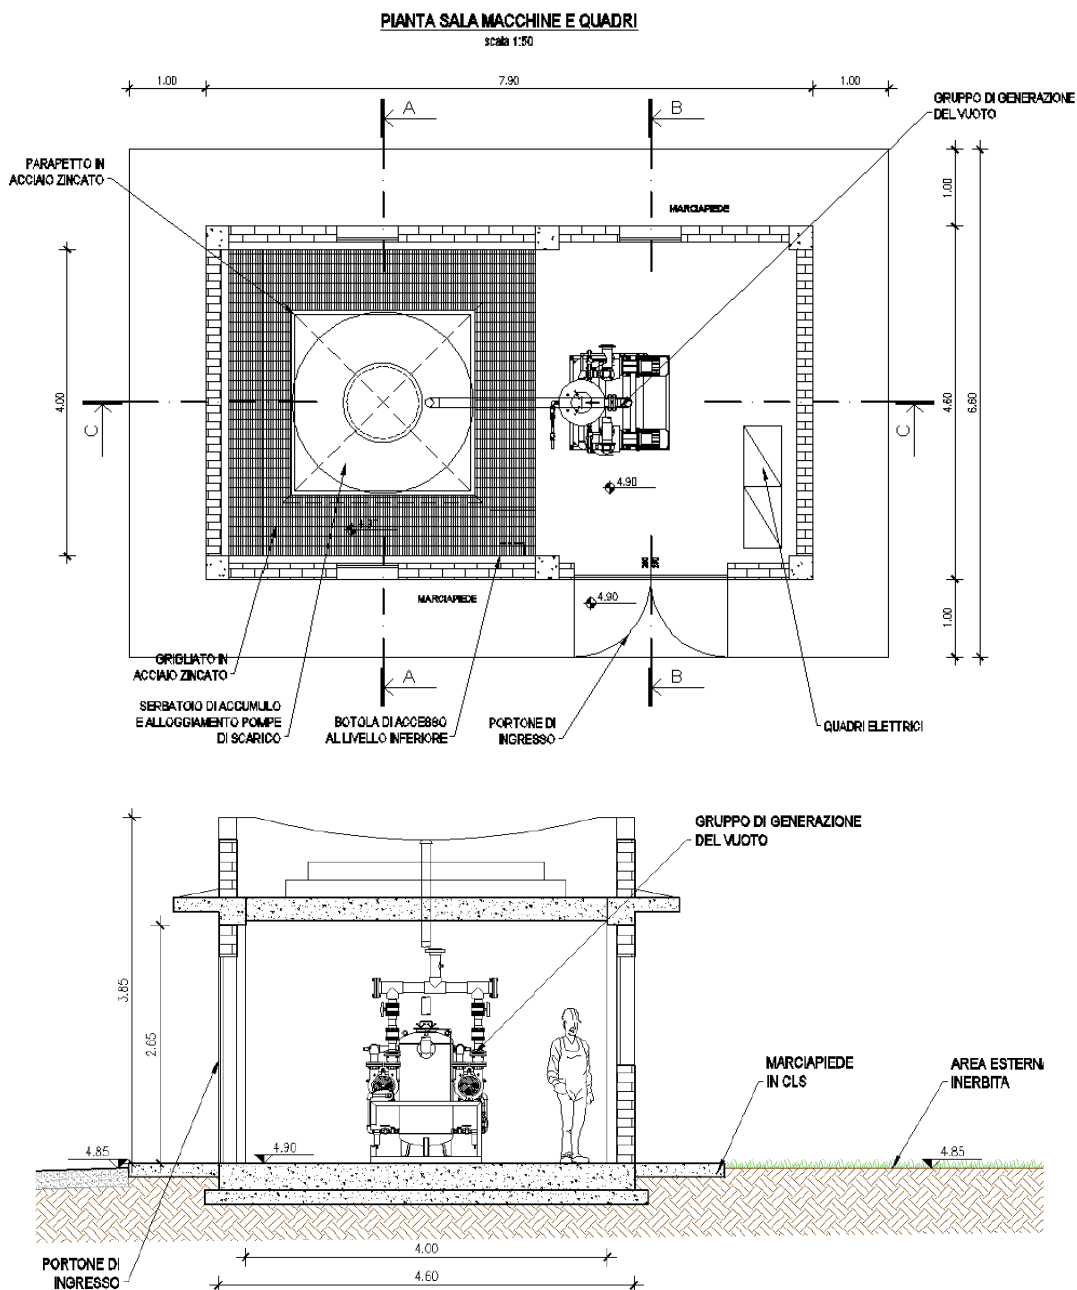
Pianta e sezioni impianto di sollevamento S1
